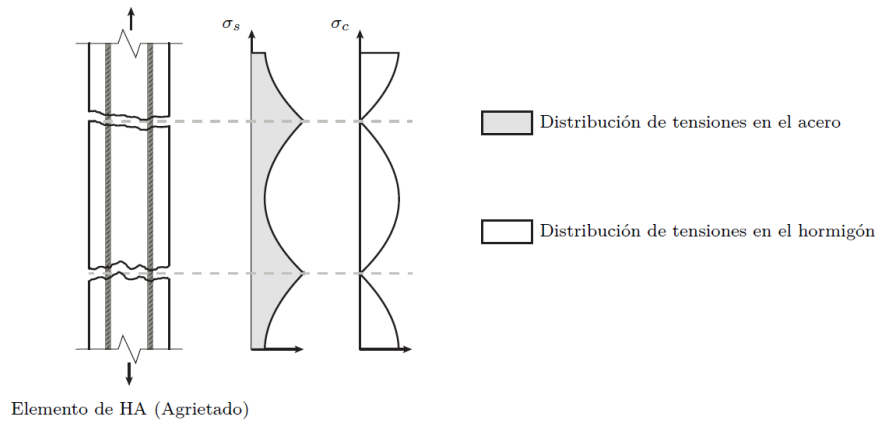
Distribución de tensiones en acero y hormigón de un elemento agrietado [33]
